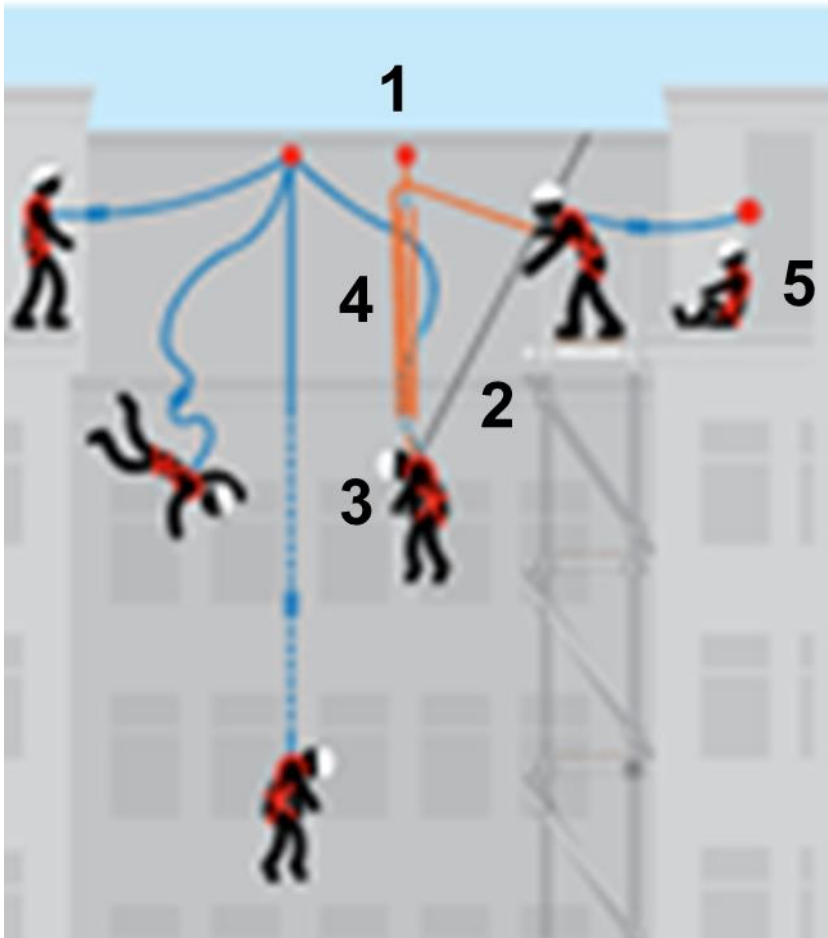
Improvisierte Rettung mit einer Rettungsausrüstung (??)
